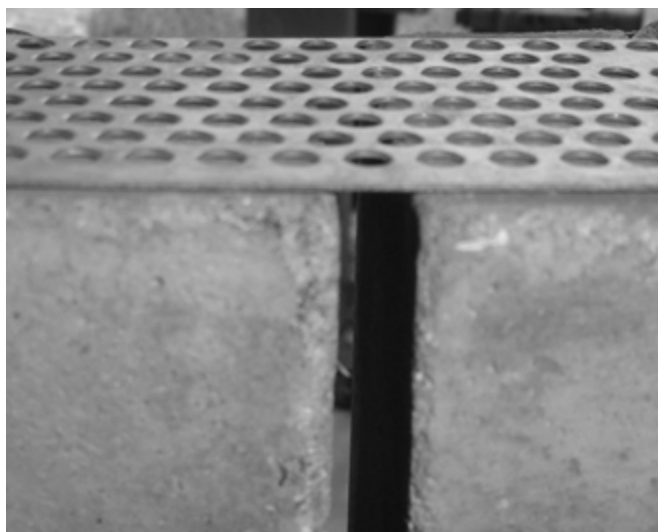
20: fixação dos painéis de parede com chapa metálica perfurada.
